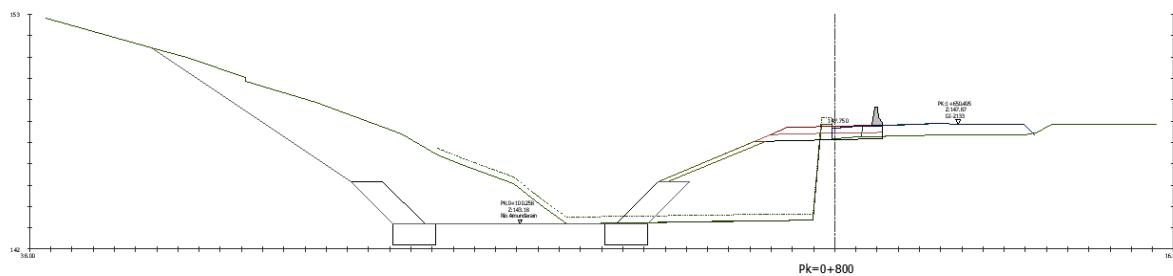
Perfil transversal PK 0+800. Fuente: Plano 6 del proyecto
